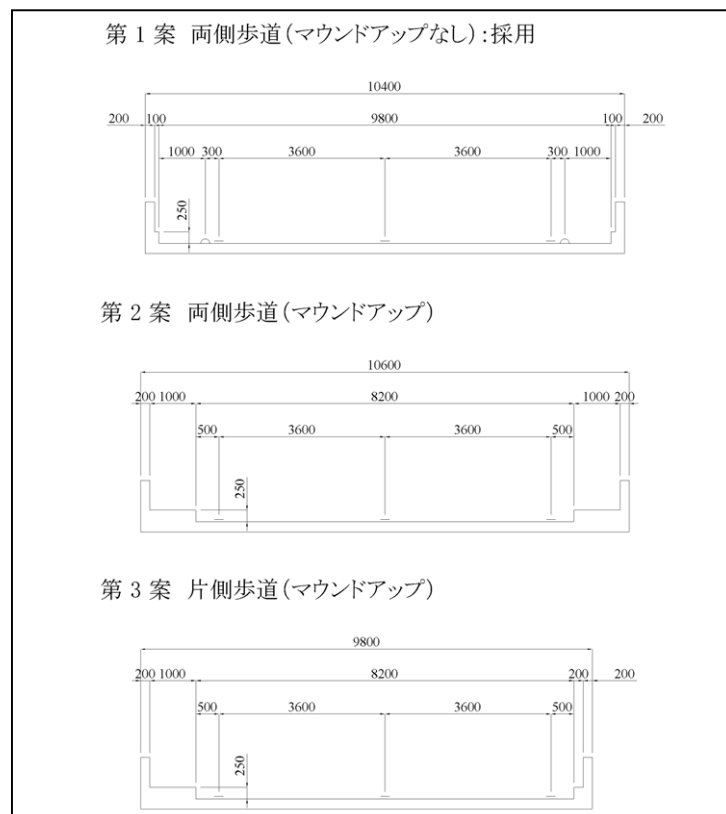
橋梁の標準幅員案 (単位: mm)
